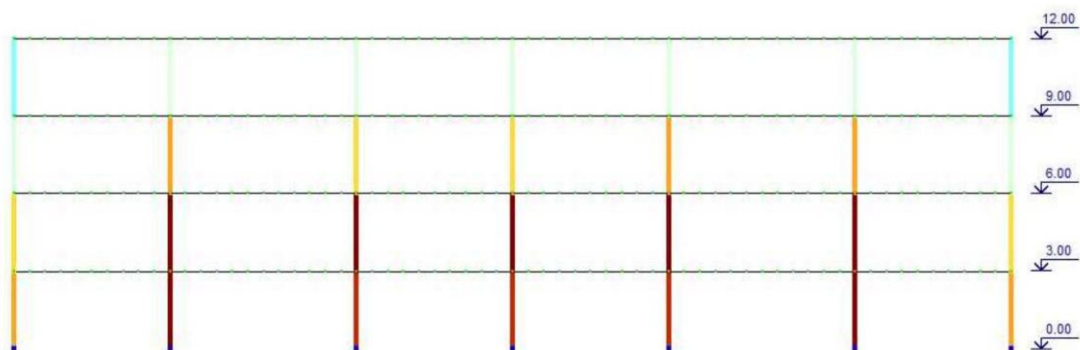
Поперечна арматура ASW2 у колонах рами по осі 7-7
